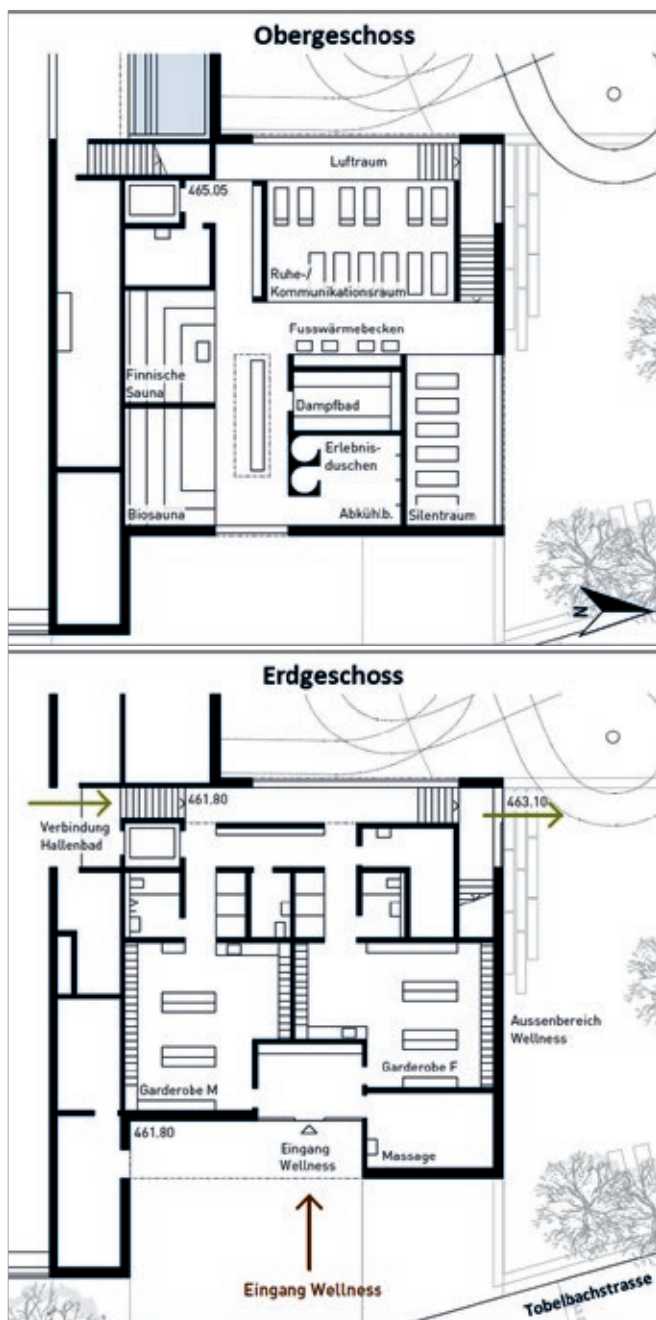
Grundriss Wellnessbereich (Erd- und Obergeschoss)
